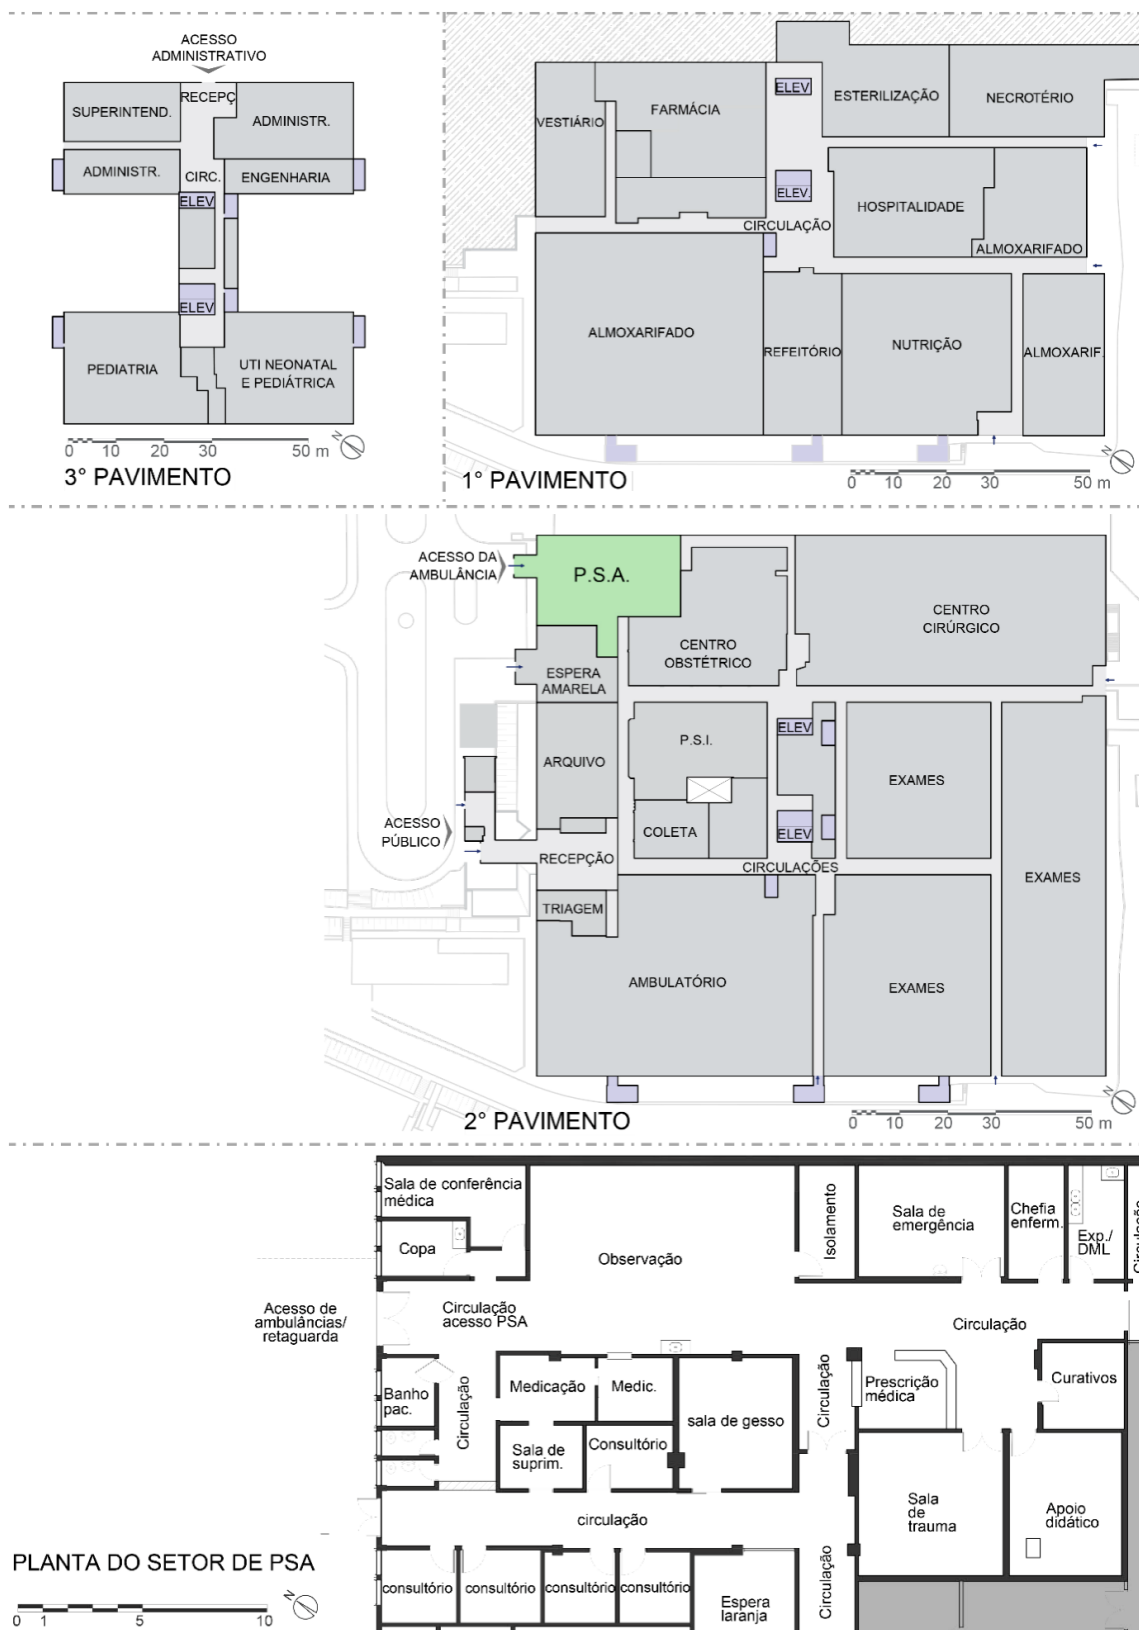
Plantas esquemáticas dos 1º, 2º e 3º pavimentos, Planta do PSA. Fonte: adaptado dos arquivos disponibilizados pela SEF HU-USP.
